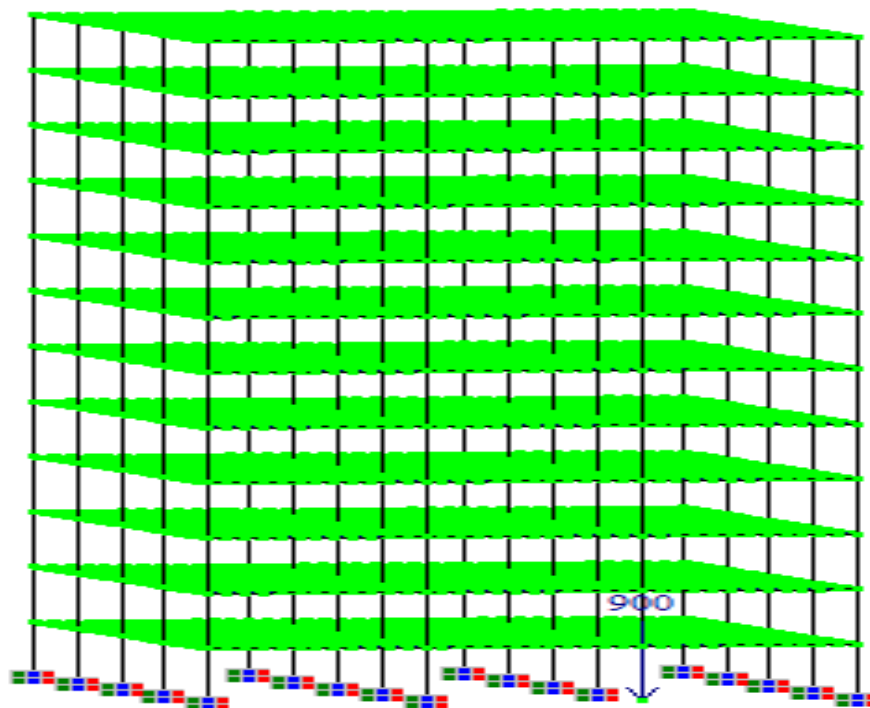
Schéma illustratif du modèle d'étude du bâtiment avec planchers sans hourdis à 12 niveaux avec un chargement vertical sur le poteau de rive
